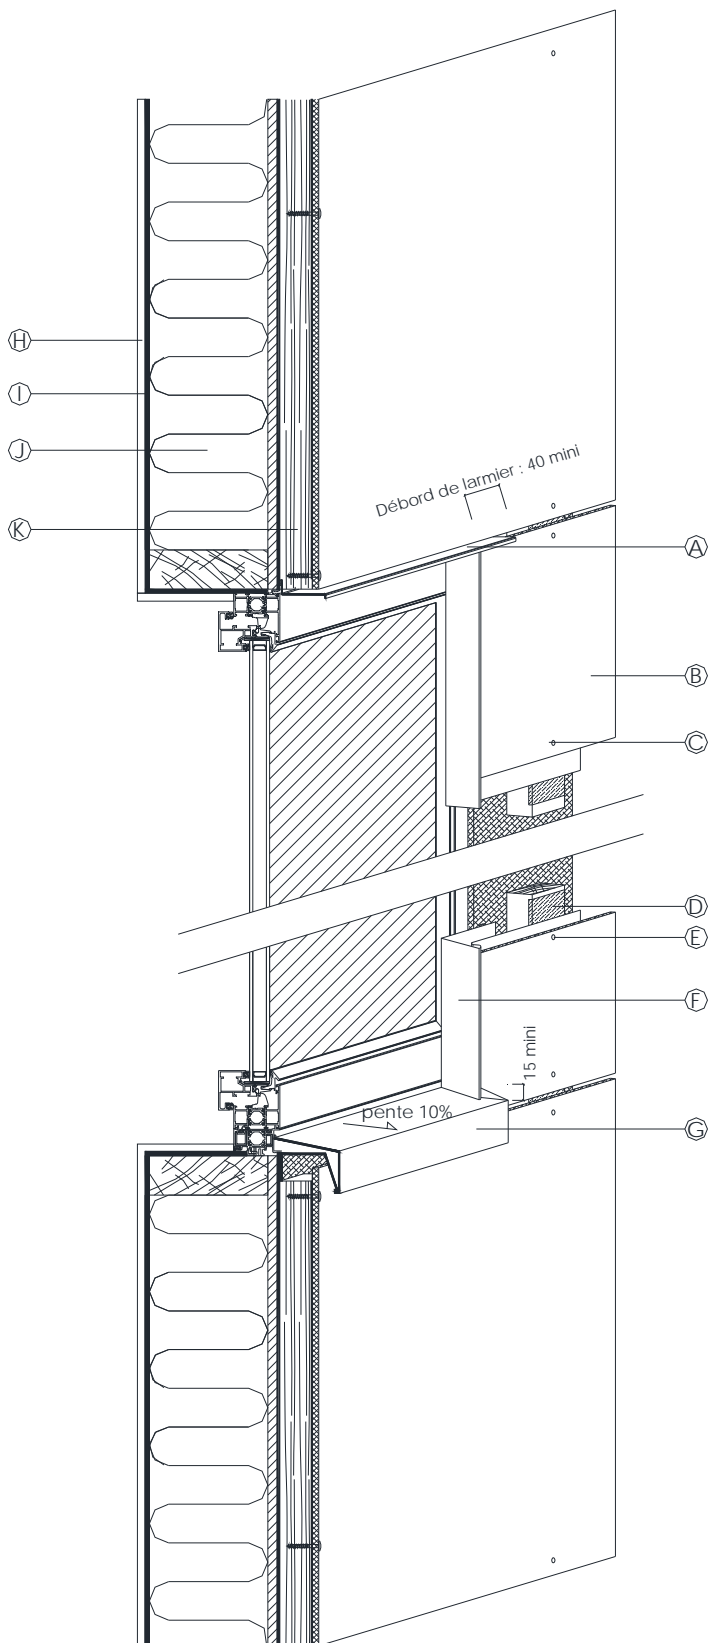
Pose sur COB – Coupe sur tableau de baie
